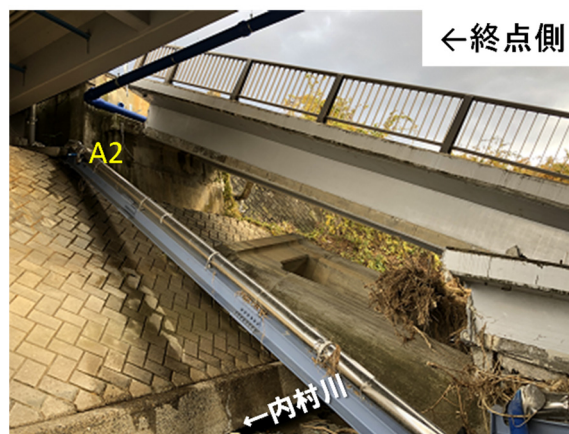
A2 橋台上の端横桁のひびわれ
